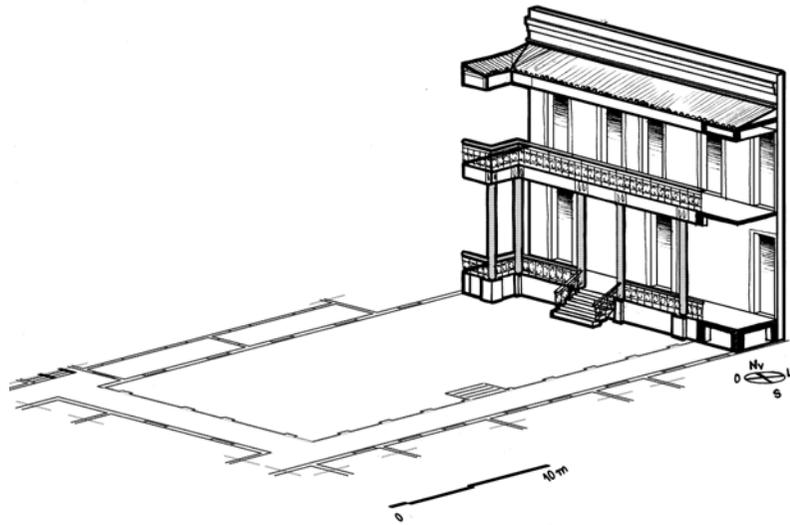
Estudo dos planos verticais, fachada Nordeste do pátio interno do CPIX.
